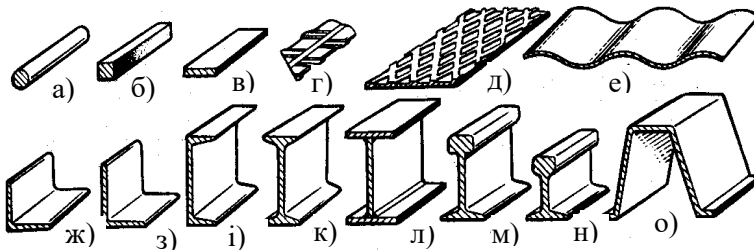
Сортамент сталей: а – кругла; б – квадратна; в – смугова; г – періодичного профілю; д – рифлена; е – хвиляста; ж – кутова рівнобока; з – кутова нерівнобока; і – швелер; к – двотавр; л – двотавр зварний; м – рейки кранові; н – рейки залізничні; о – шпунтова паля
